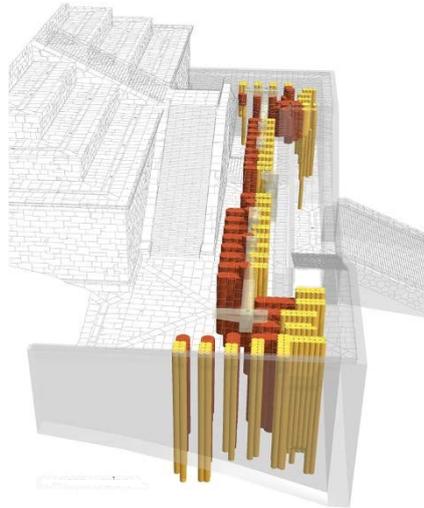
Betonpfeiler (© Ing.-gem. Walhalla)
